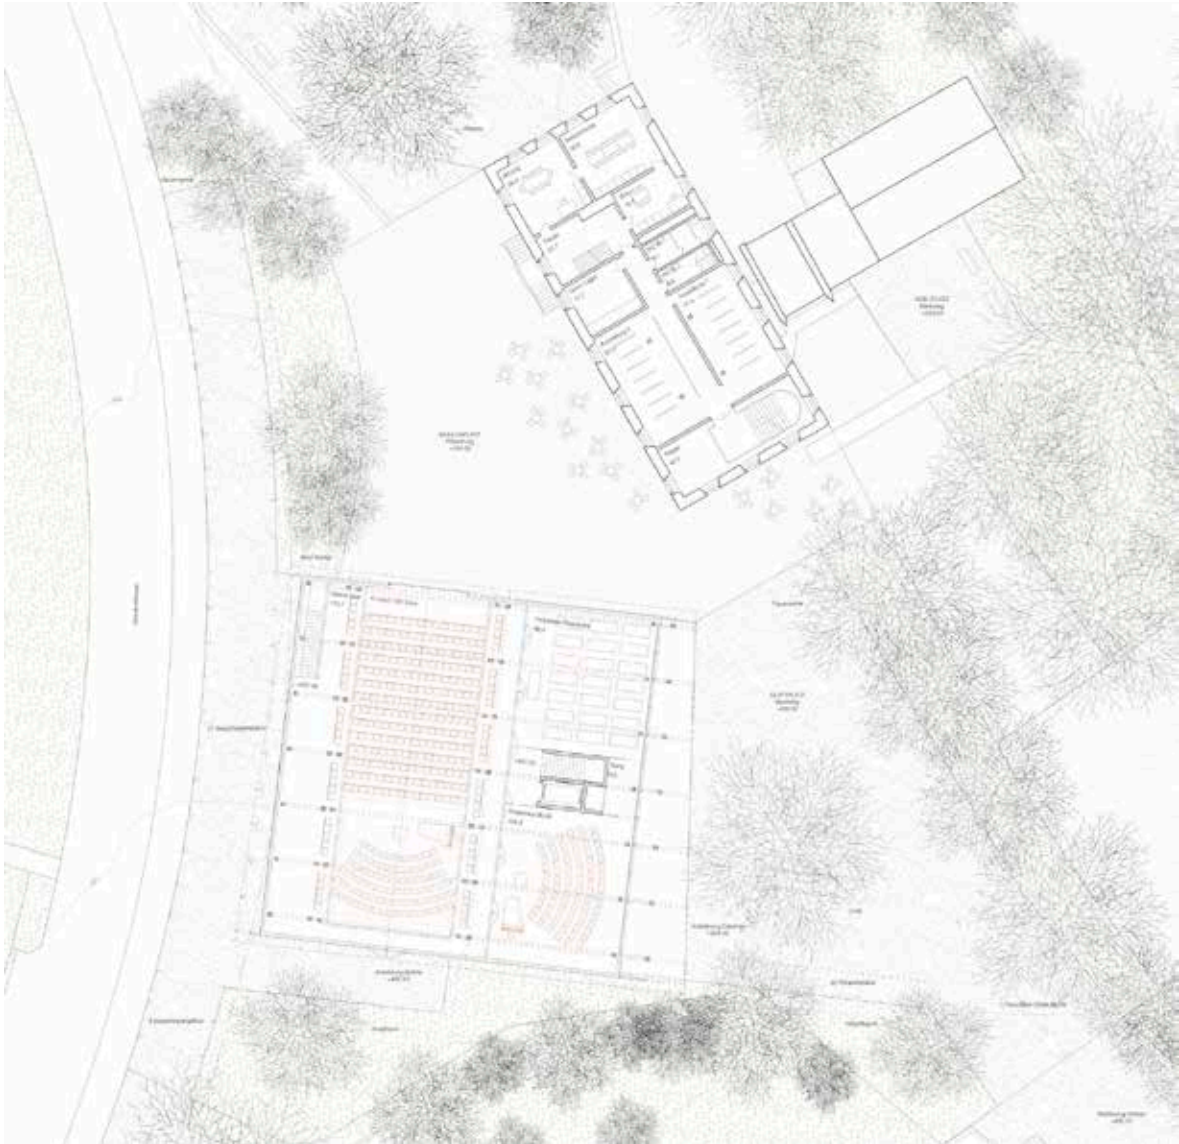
Grundriss Erdgeschoss o.M.
